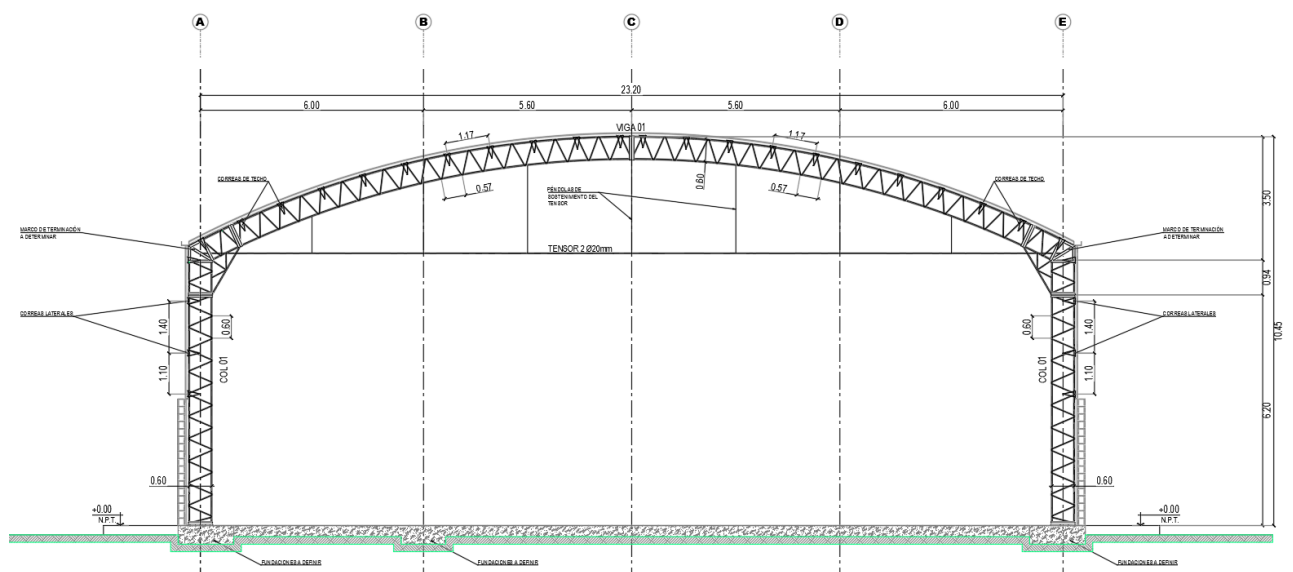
PÓRTICOS | CORTE TRANSVERSAL – EJES 2 A 5
